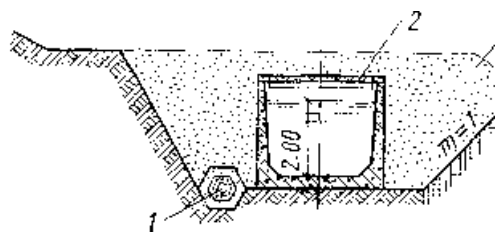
Железобетонный закрытый лоток: 1 – дренаж, 2 – железобетонная плита, 3 – обратная засыпка
